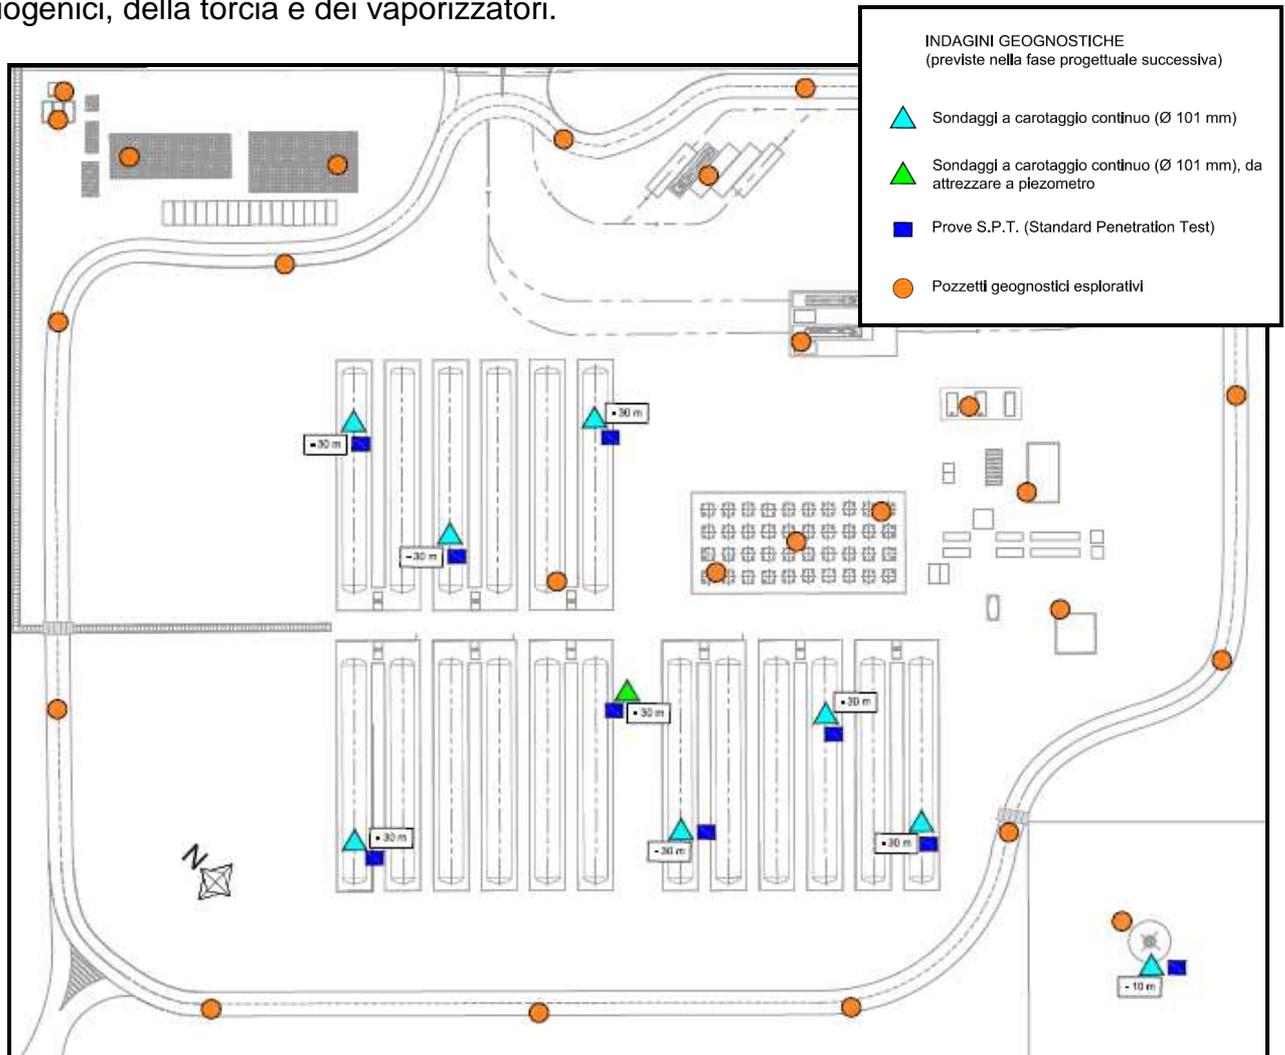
Stralcio della planimetria indagini geognostiche previste.
